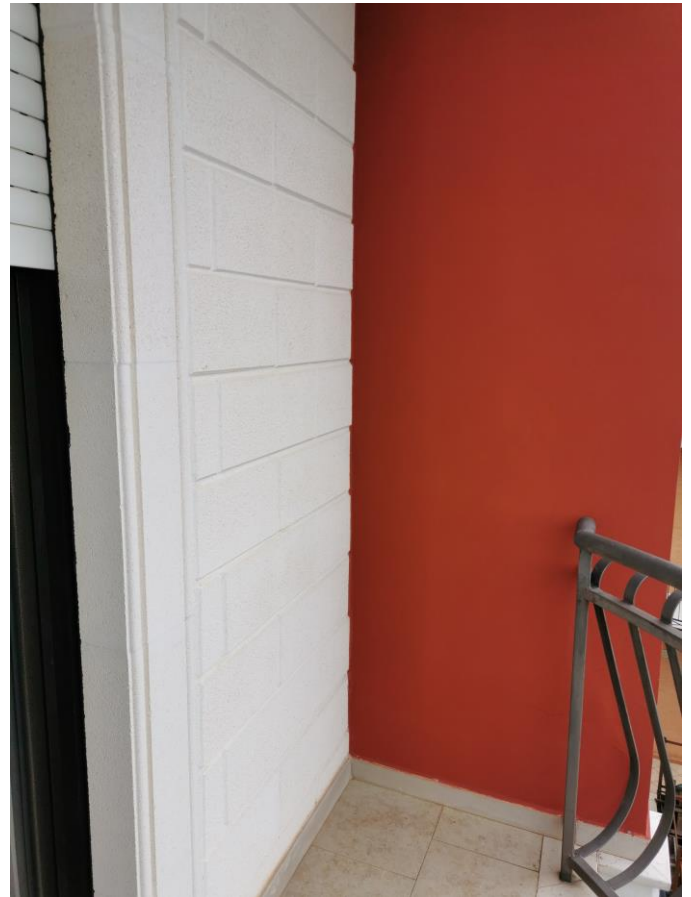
Piano Primo –camere hotel su via Roberto Rossellini
